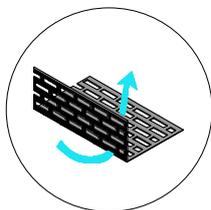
Kombinationsfassaden - Klinkerfassader (horizontal)
